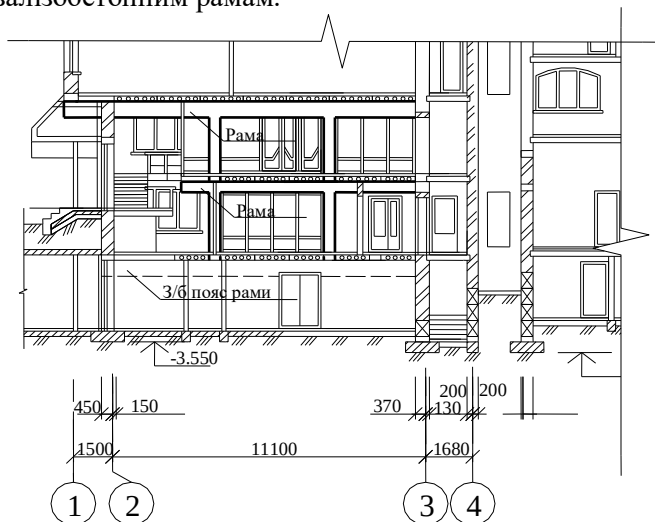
Монолітна залізобетонна рама в житловому будинку.
